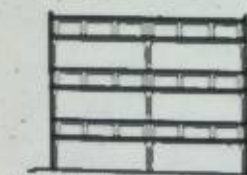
Схема многоэтажного производственного здания с межферменными этажами в перекрытиях из бесраскосных ферм с параллельными поясами.
